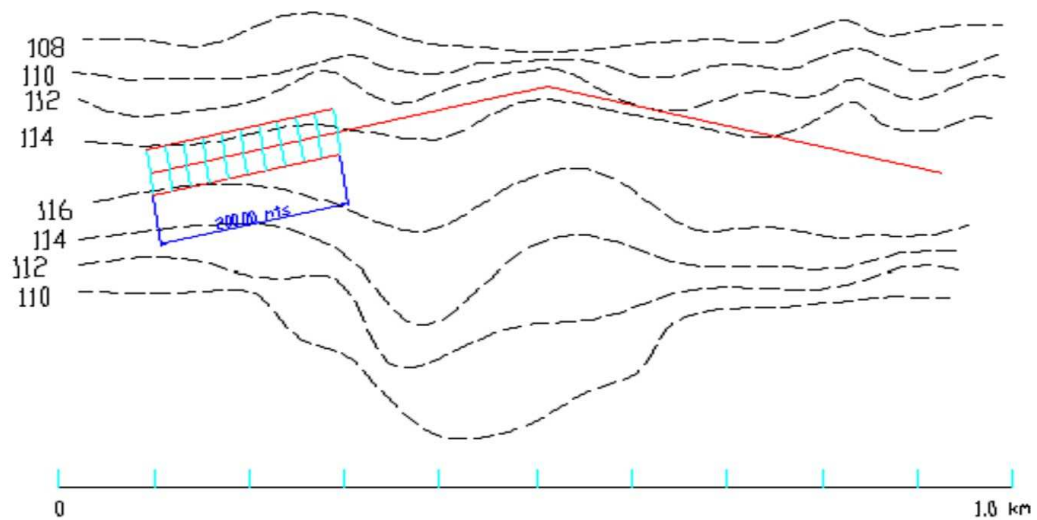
Secciones de construcción en un tramo de 200 m
